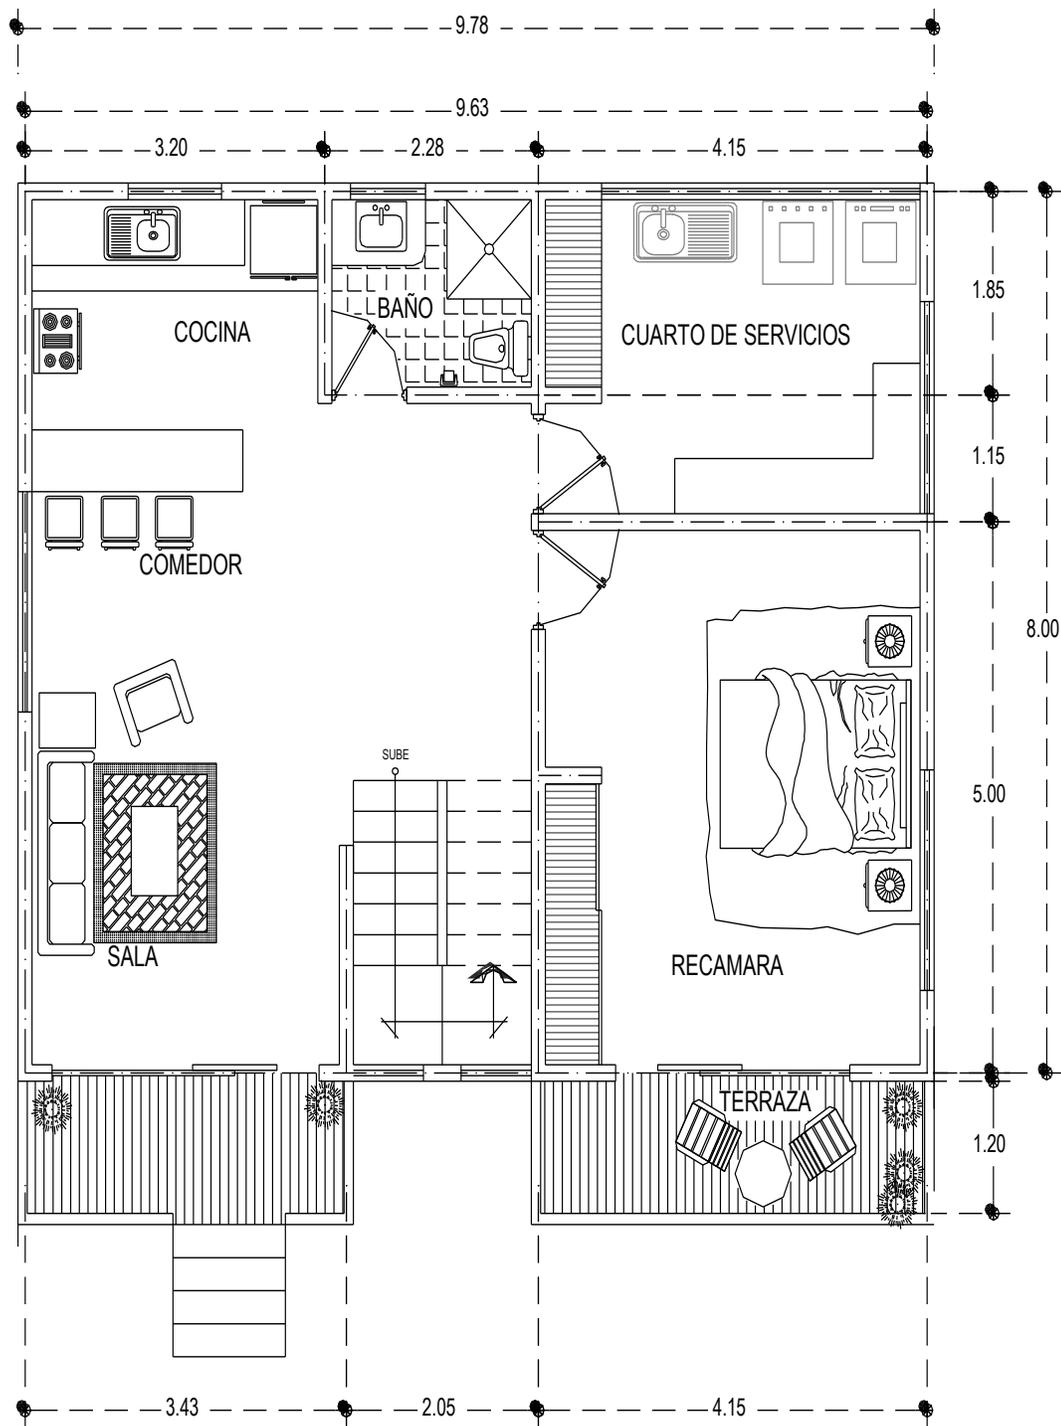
Planta arquitectónica baja de la casa habitación.
